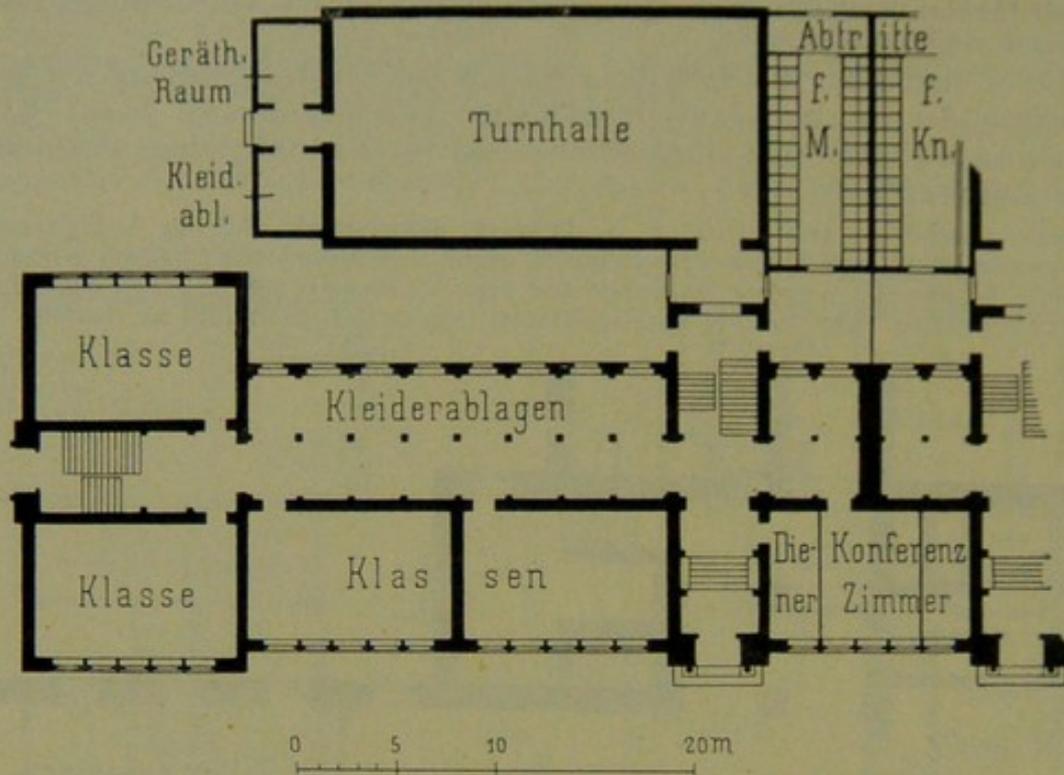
Zweiunddreißigklassige Schule in Frankfurt a. M. Grundriß des Erdgeschosses. Aus St. BLATTNER¹⁾.
